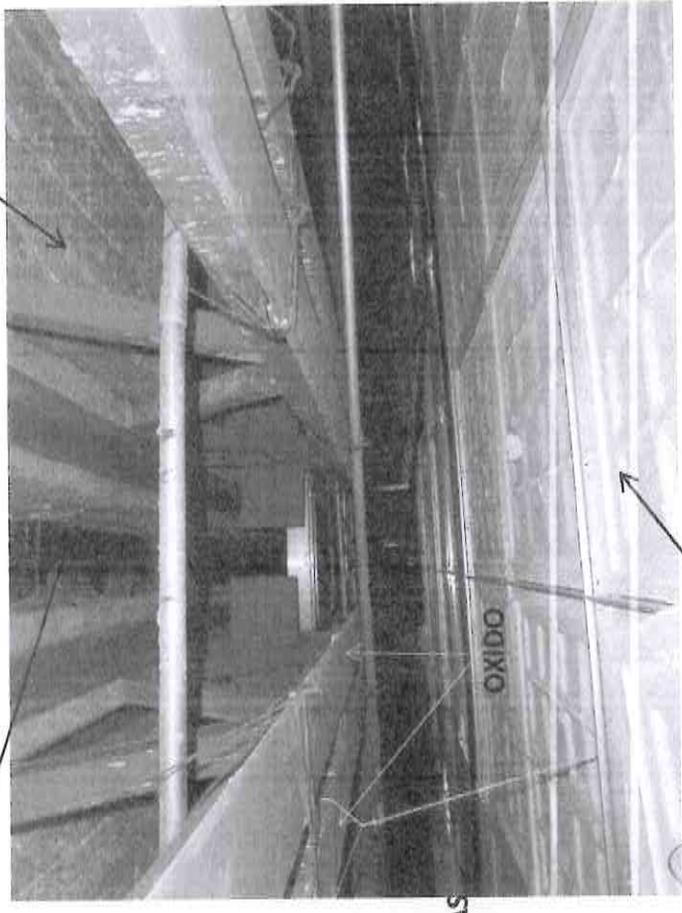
y 34.- No se advierten por efecto del sismo daño en las armaduras y paneles de siporex.
